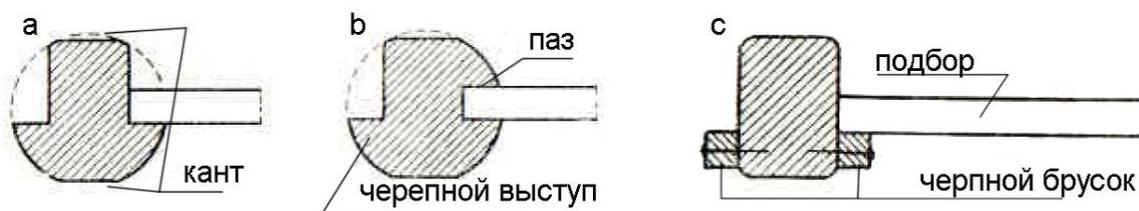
Сечения деревянных балок перекрытий: а – бревенчатая балка с черепными выступами (четвертями); б – бревенчатая балка с четвертью и пазом; в – брусчатая балка с черепными брусками [33]
